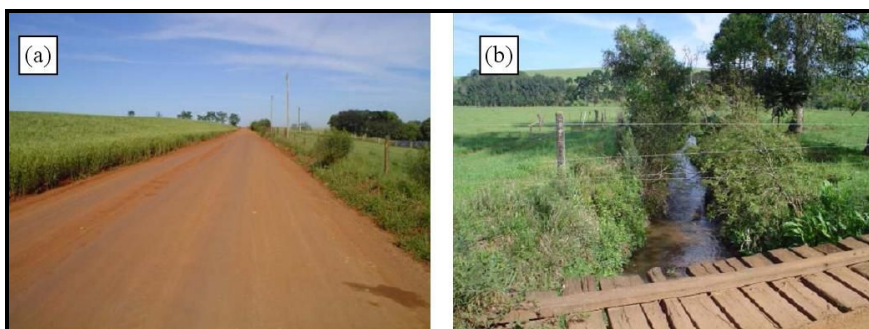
(a) Vista da estrada vicinal, estacas 20 a 25 (b) Pontes de madeira, estacas 160 a 165.
